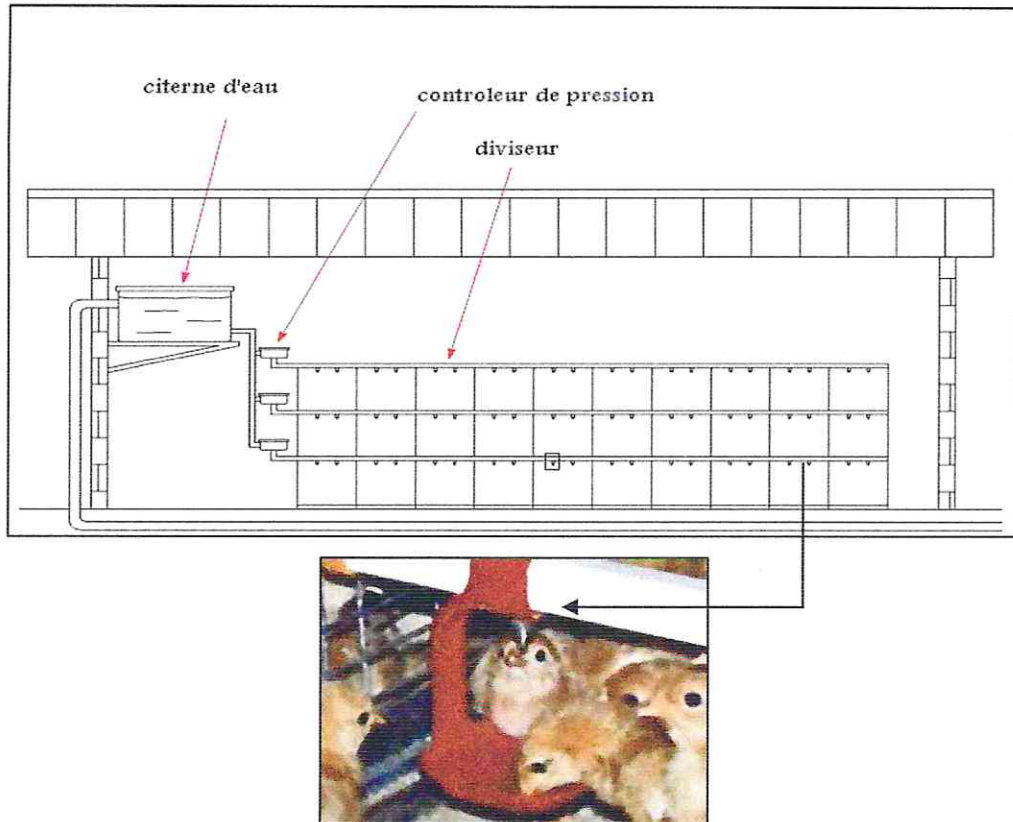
Plan d'installation des réservoirs d'eau et abreuvoirs
